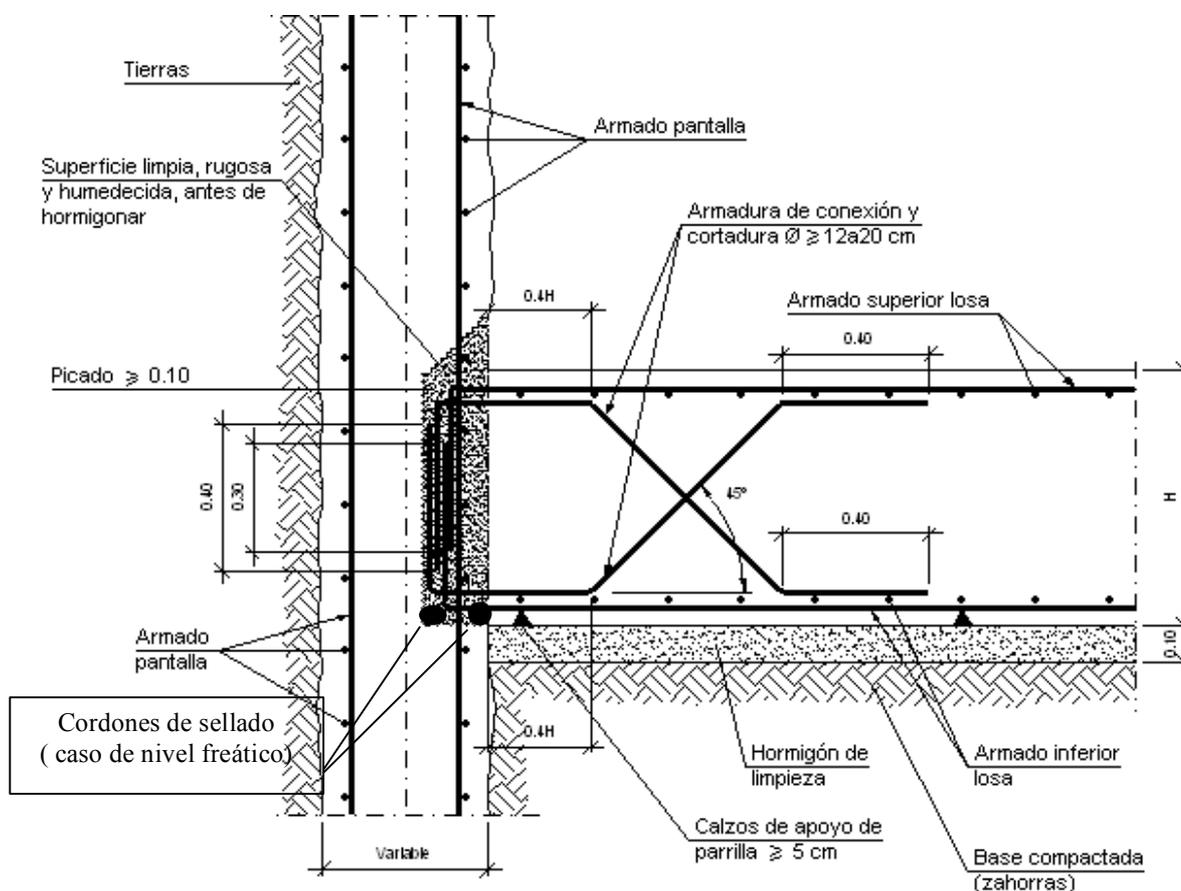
Detalle 1: Picado del muro pantalla para alojar armaduras de conexión (Vicente Ordura Vidal, 2015)
